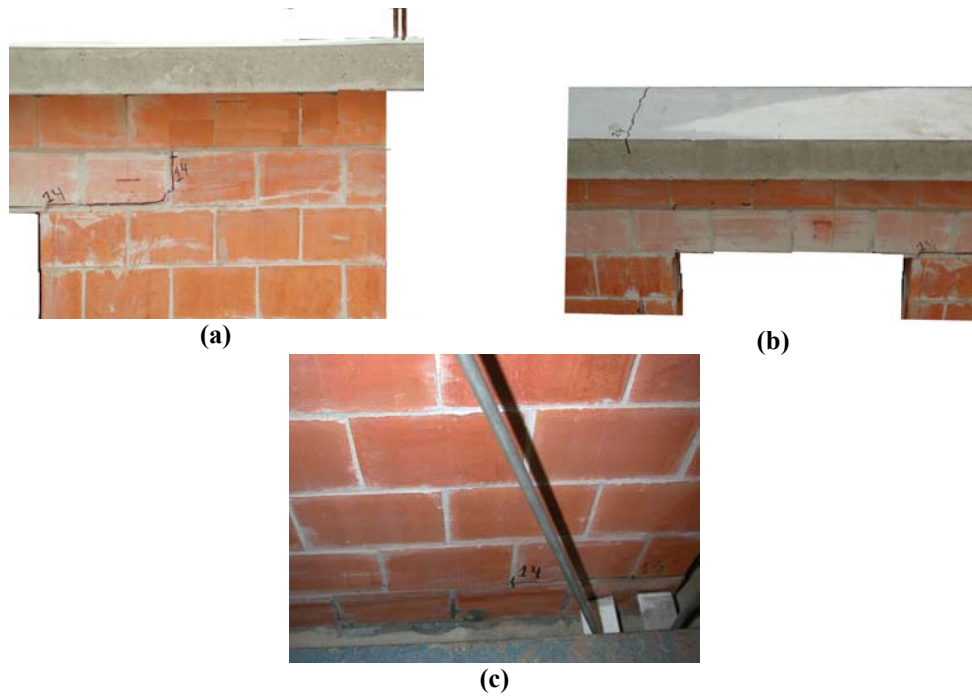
Primeiras fissuras visíveis – PPSG2: (a) Canto da abertura e extremidade do lintel; (b) Topo da laje; e (c) Base da parede P2.
